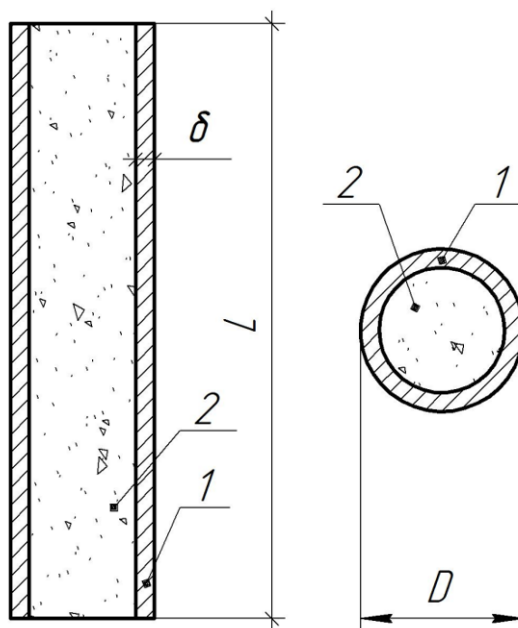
Розрахункова схема сталобетонної колони: 1 - сталева обойма; 2 - бетонне ядро
